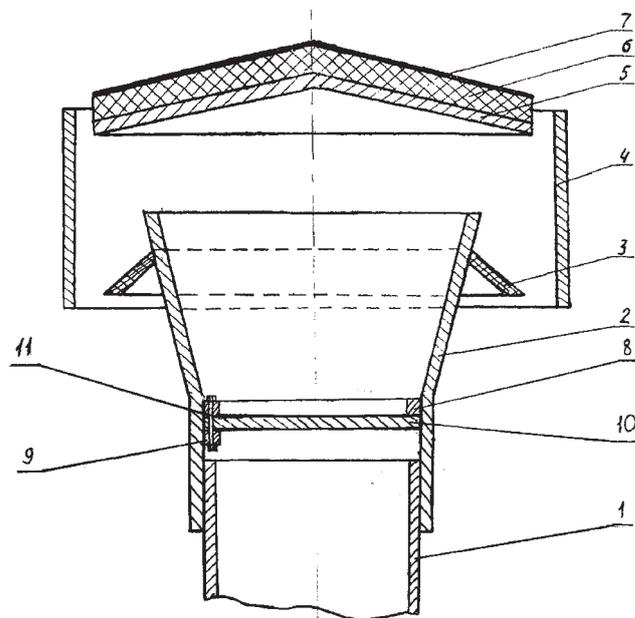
Дефлектор для вытяжной вентиляционной трубы со сменным фильтром: 1 – вентиляционная труба; 2 – диффузор; 3 – юбочка; 4 – обечайка; 5 – зонт-колпак; 6 – теплоизолирующий слой; 7 – экран; 8 – уплотнительное металлическое кольцо прямоугольного сечения; 9 – опоры; 10 – сменный фильтр; 11 – болты
